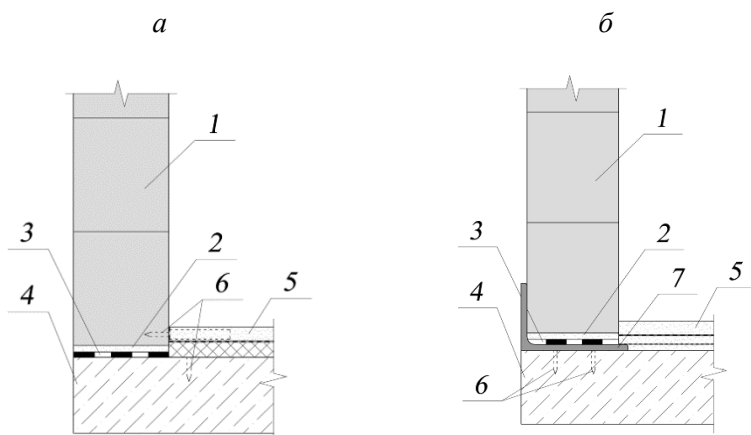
Пример сопряжения наружной стены с нижним перекрытием:
